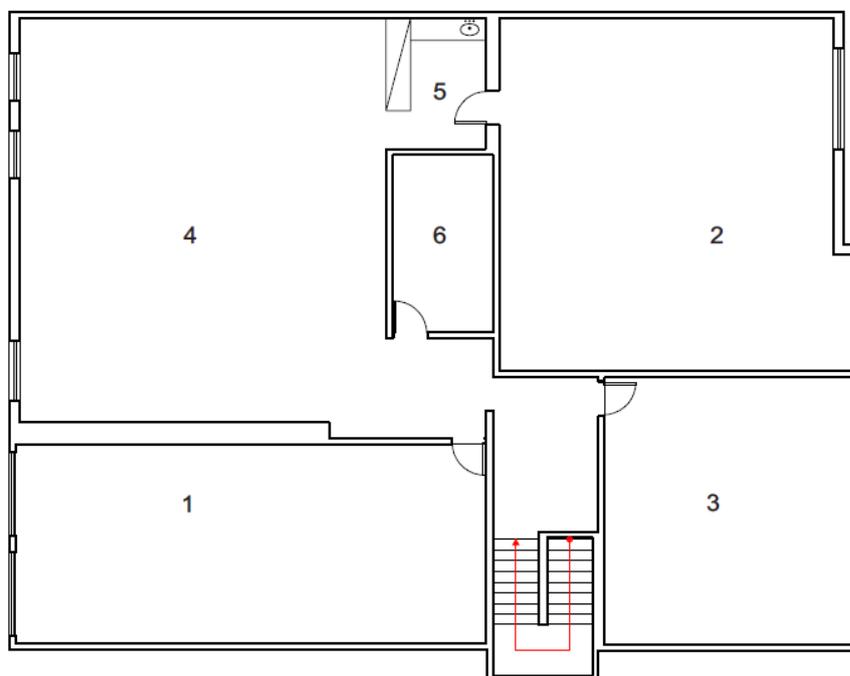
PLANTA SEGUNDO PAVIMENTO – SEM ESCALA
